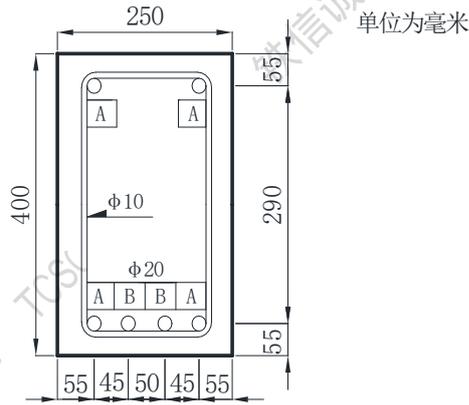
4.5m 钢筋混凝土模型梁配筋构造立面
